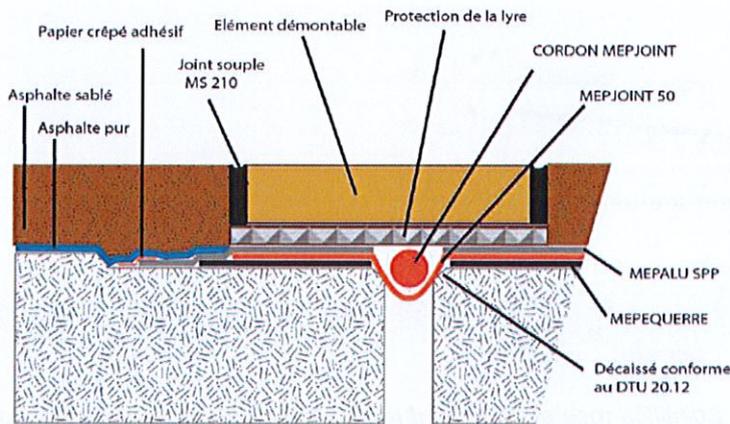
Exemple de joint plat en partie courante raccordé à une étanchéité asphaltée cf. § 4.42
